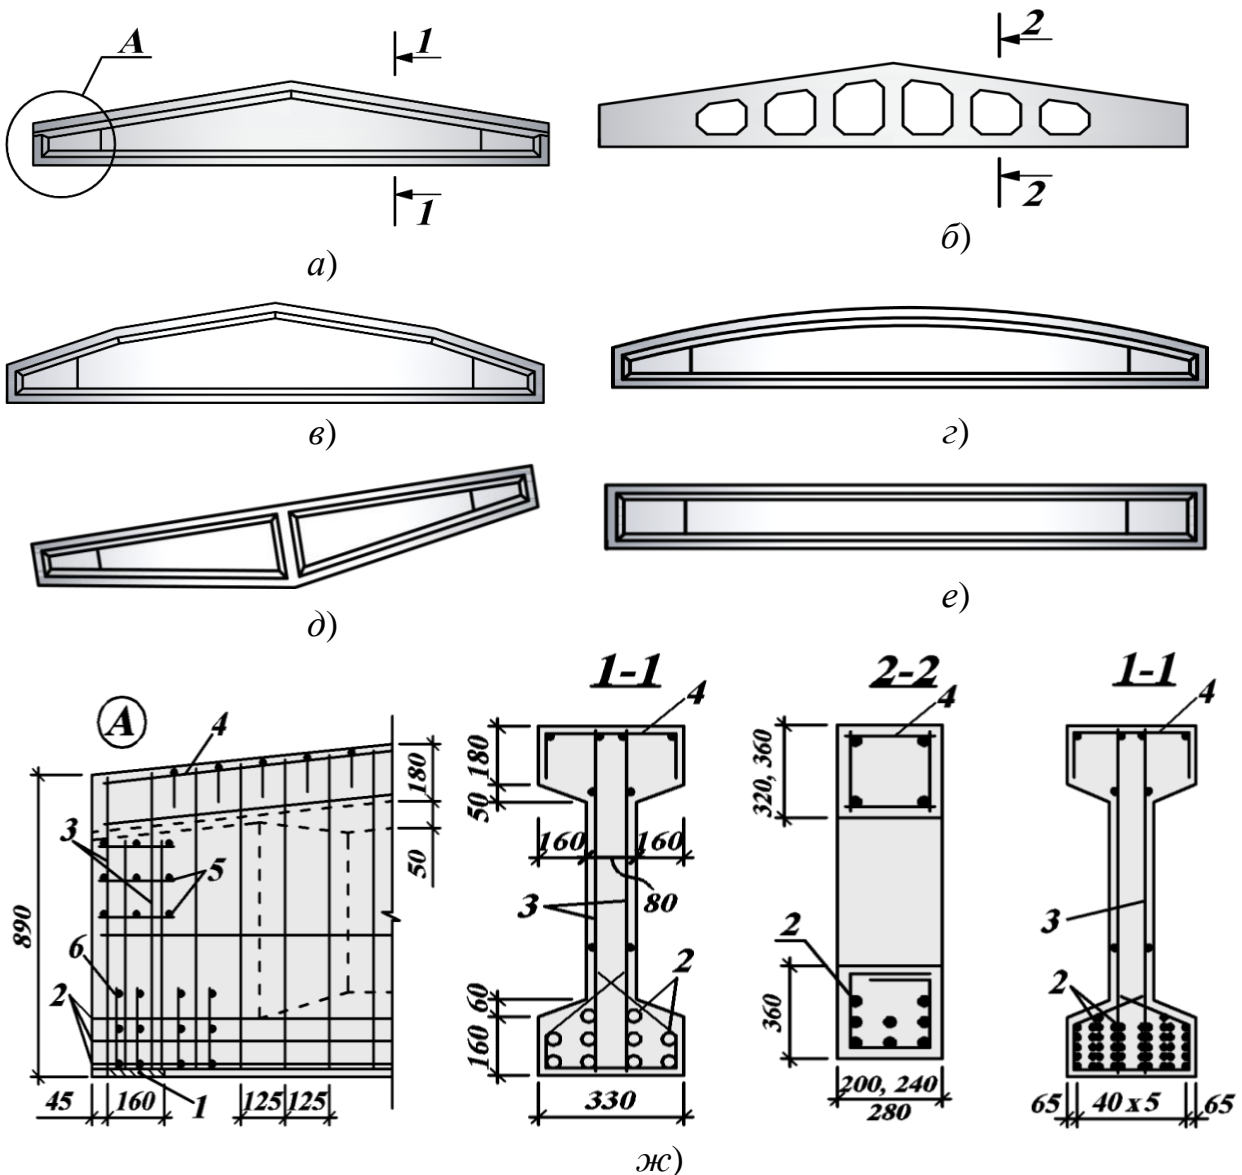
Конструкції крокв'яних залізобетонних балок:
